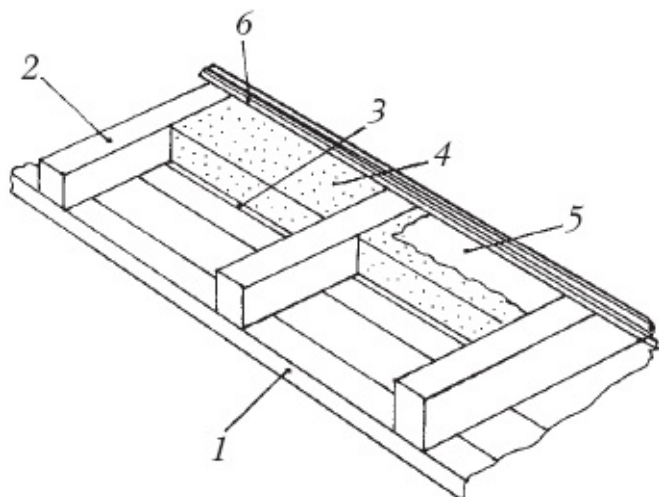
Конструкция потолочного «пирога»: 1 – потолочный щит; 2 – балка; 3 – пароизоляция; 4 – утеплитель; 5 – гидроизоляция; 6 – дощатый настил
